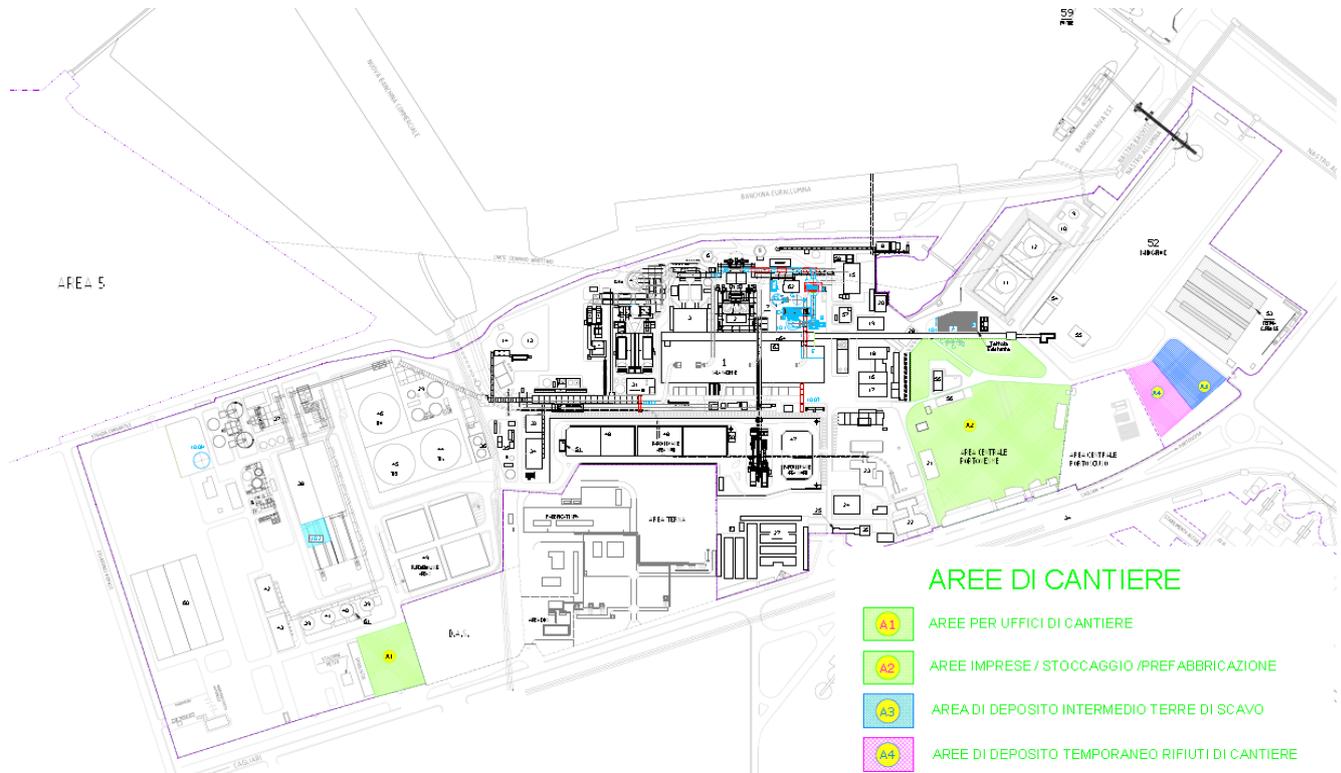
Ubicazione sito di deposito intermedio (Fonte: SUODCAAS016-00 Planimetria impianto - Aree di cantiere)
